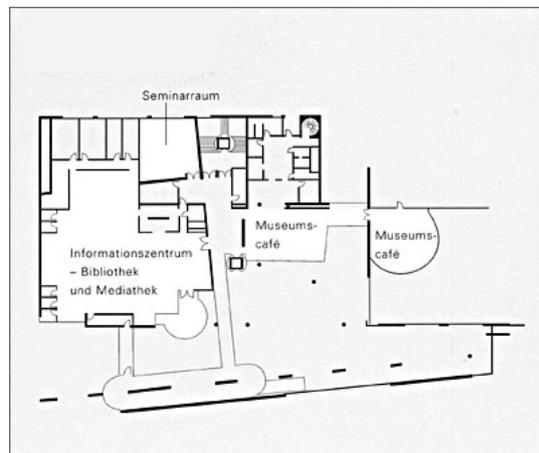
HDG – Grundriss Zwischengeschoss
